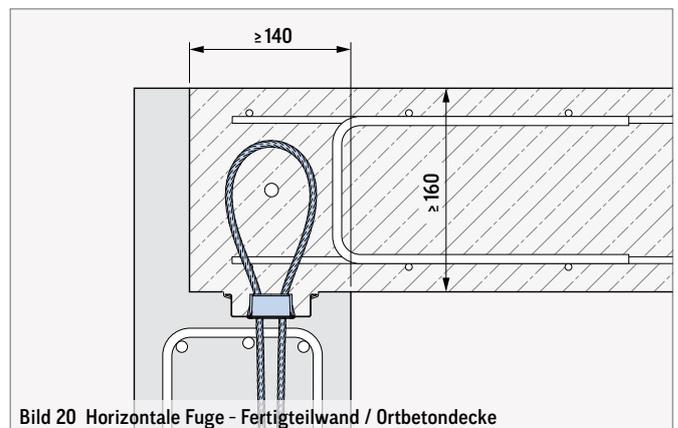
Horizontale Fuge - Fertigteilwand / Ortbetondecke
